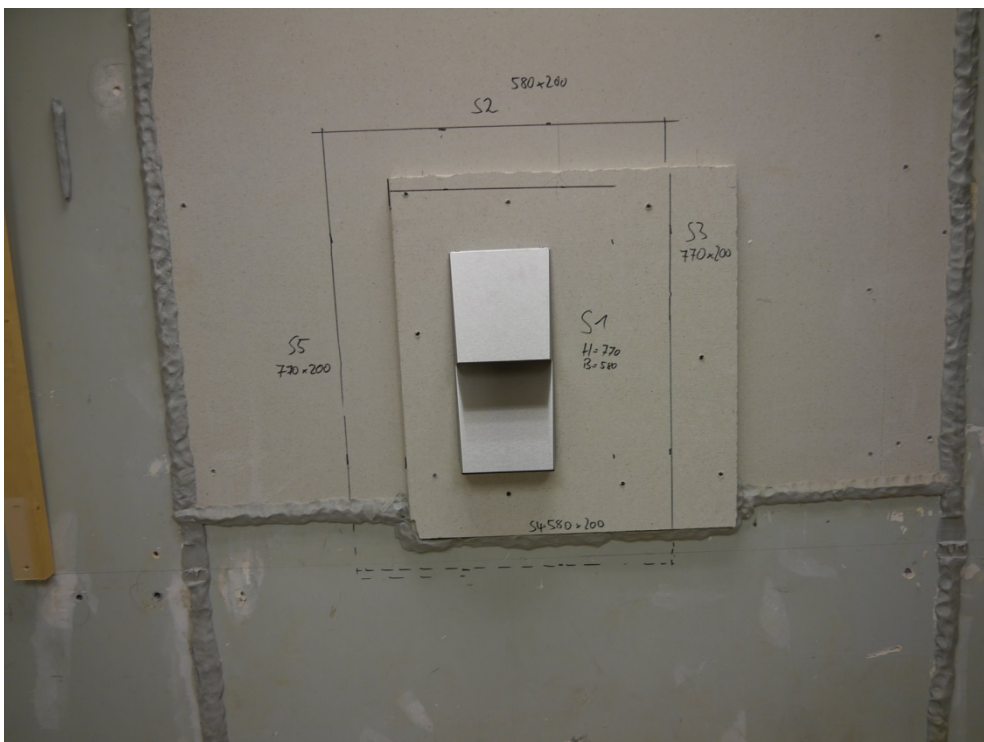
Variante Standardfassadenabschluss ES: Lüftungsöffnungen außenseitig mit montiertem Fassadenabschluss Edelstahlschote (prüffertig).
